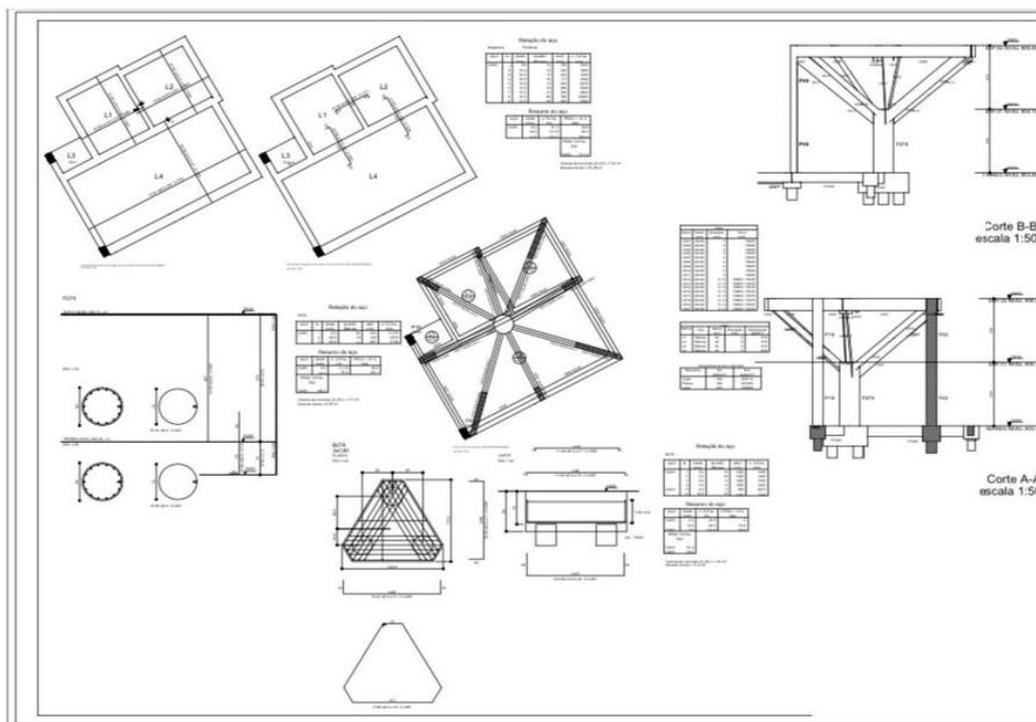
Projeto executado, aprovado pelo Engenheiro calculista.
